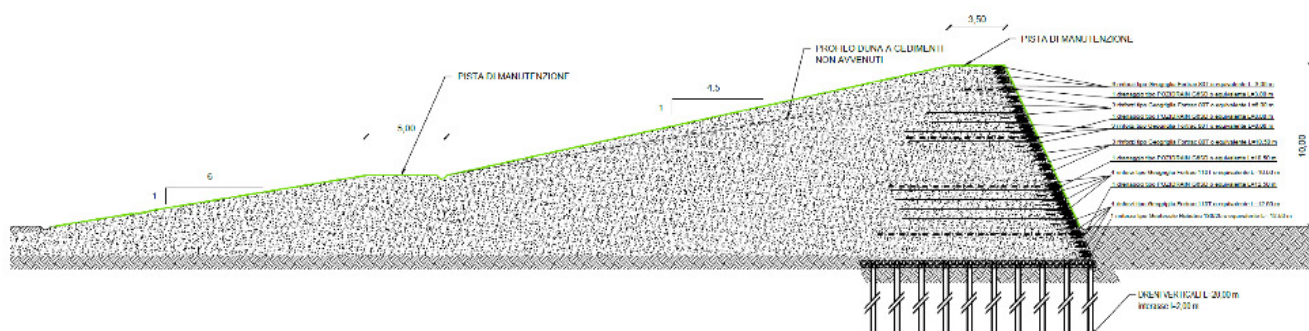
Sezione tipo con doppio fronte in terra rinforzata - Sezione tipo C.
